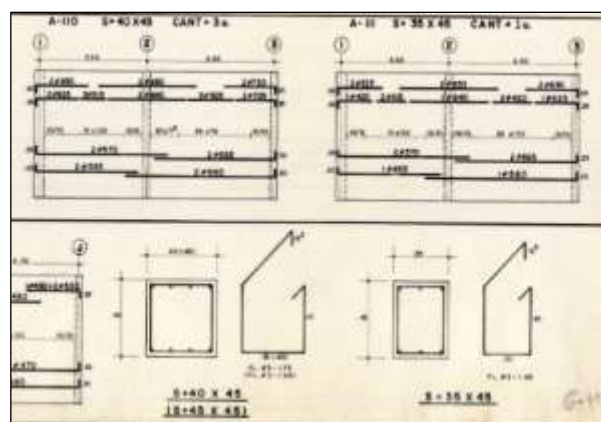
Fuente: autores, Despiece de vigas alcaldía Yopal, planos originales alcaldía por Ing. Carlos Navas Camargo.
